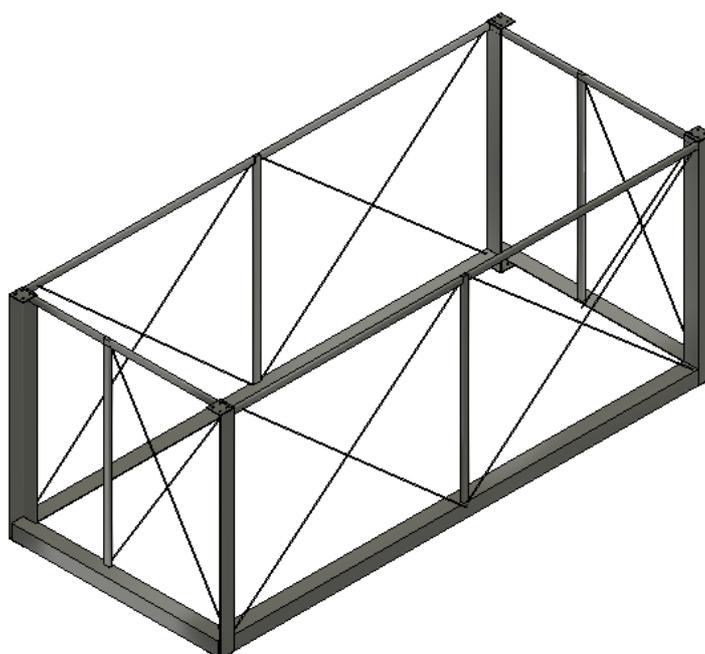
Estrutura com as vigas de bordadura, tirantes e chapas de apoio
